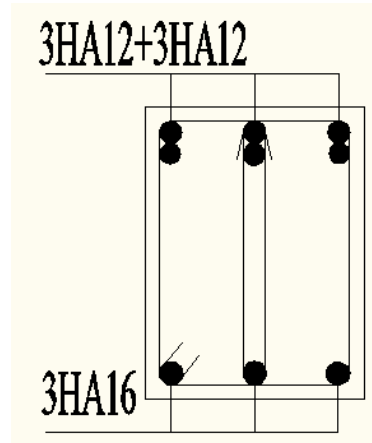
Ferrailage en travée d'une poutre secondaire.
